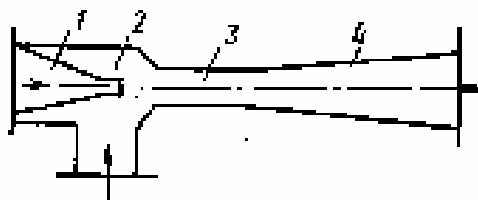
Схема элеватора: 1 – сопло; 2 – камера всасывания; 3 – камера смешения; 4 – диффузор
